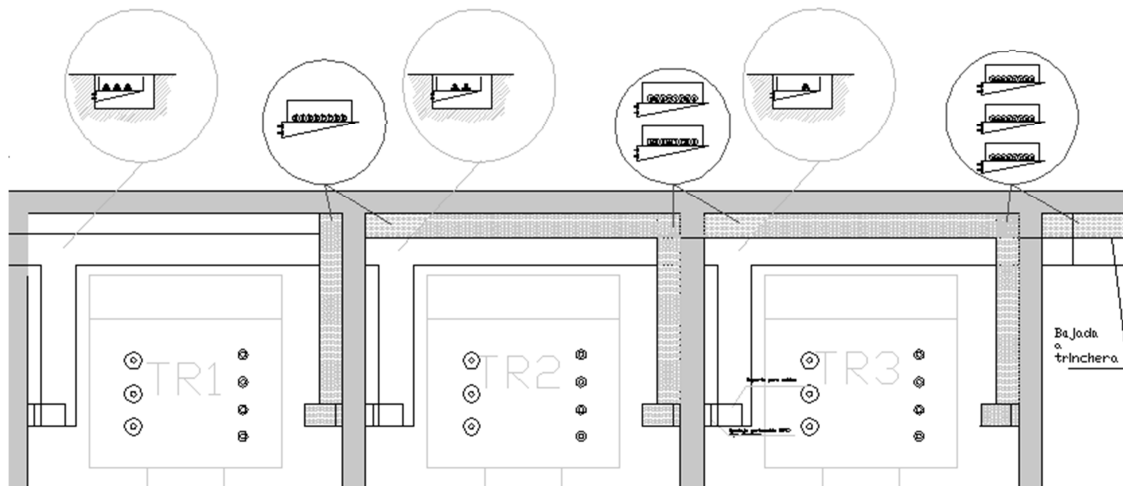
Vista en planta de sala de transformadores. Detalle trincheras y bandeja.
